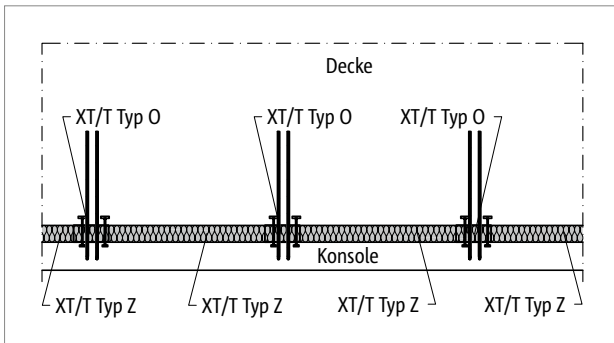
Schöck Isokorb® XT/T Typ O, Z: Konsole
